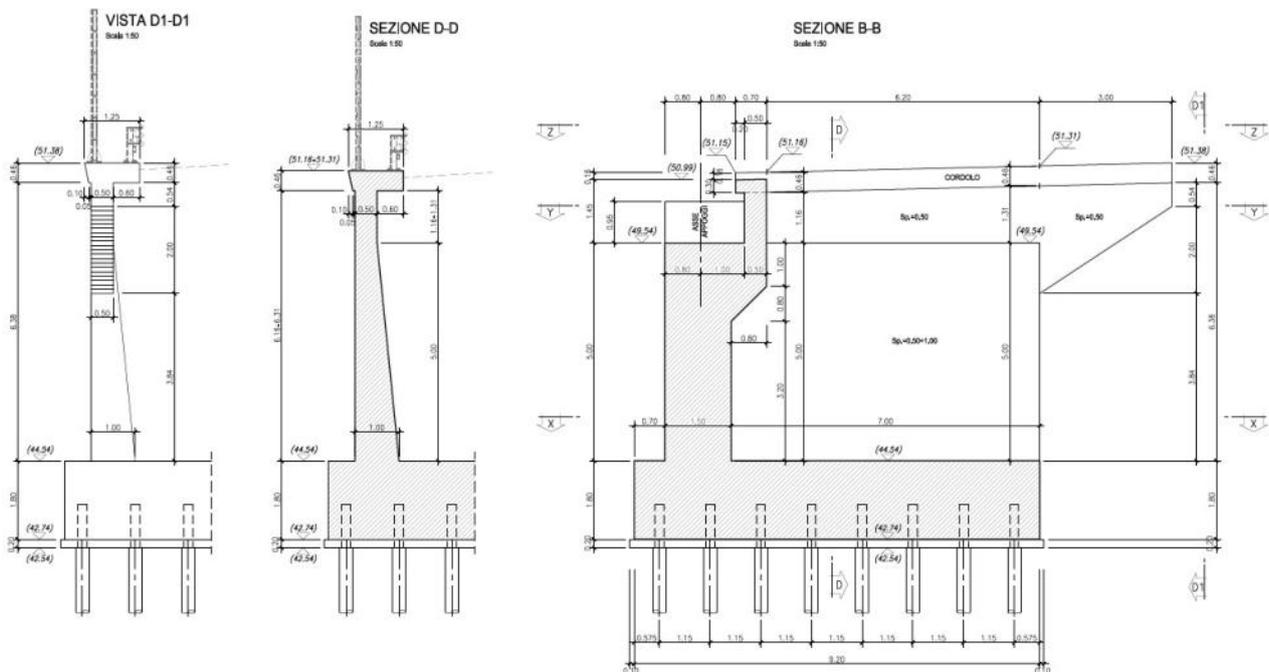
sezione trasversale e longitudinale spalla.
